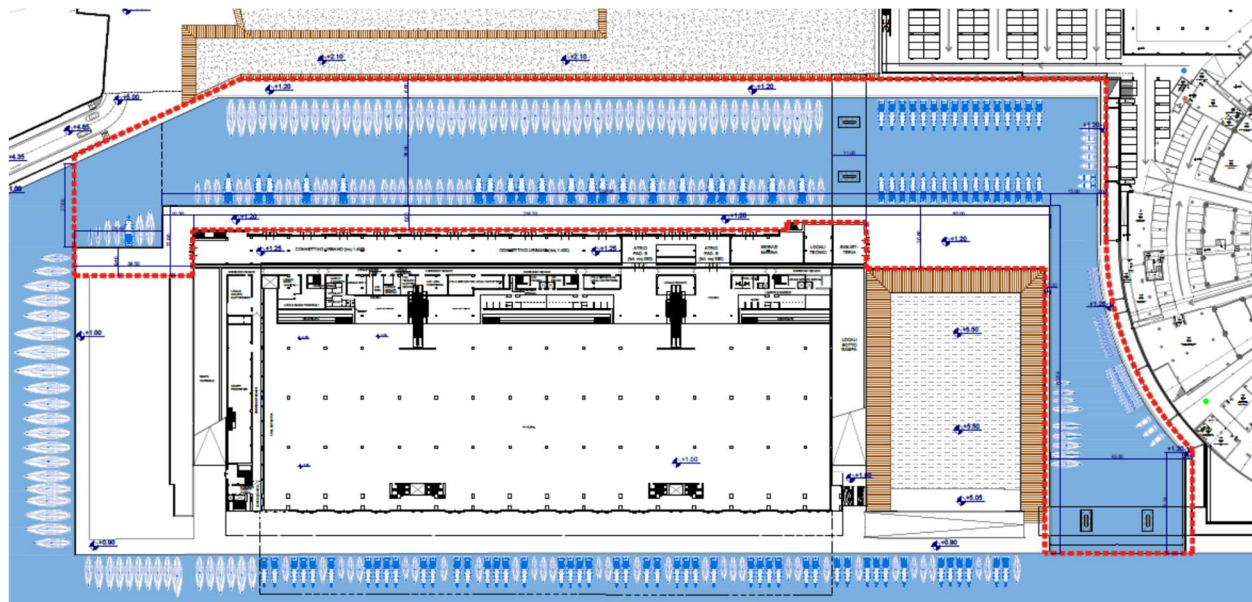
Planimetria di progetto a quota banchina – Stralcio elaborato Ar-T-05
